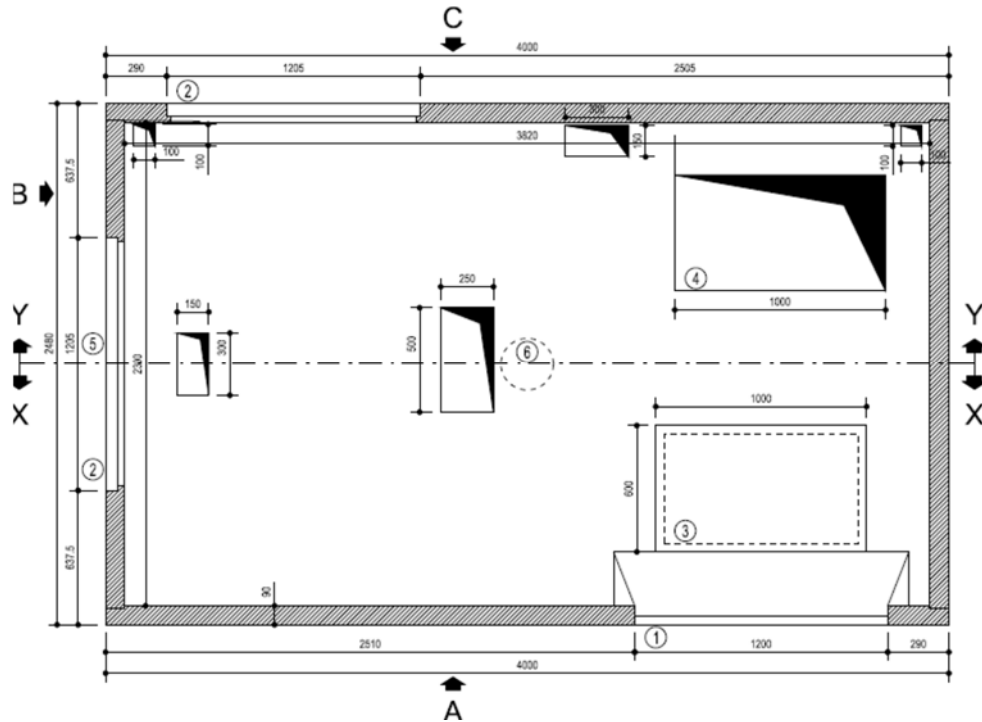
FIGURA – VISTA IN PIANTA DELLA CABINA UTENTE
